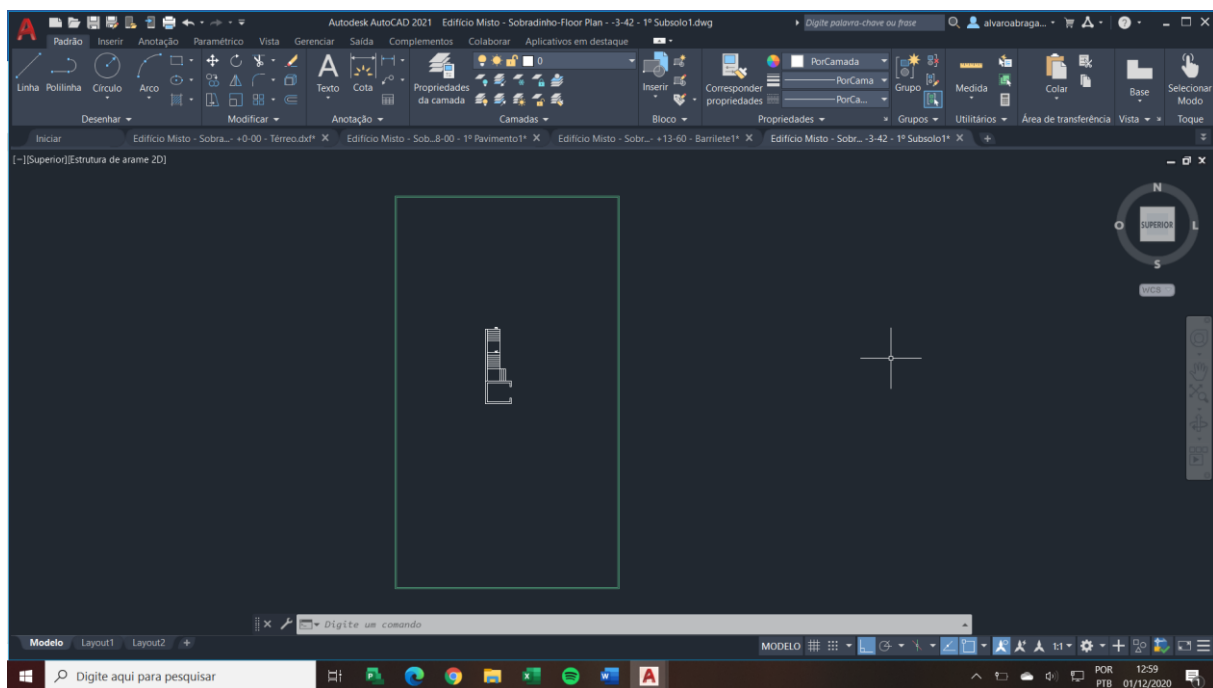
Planta baixa do subsolo, em DWG. Realizado pelo autor.
